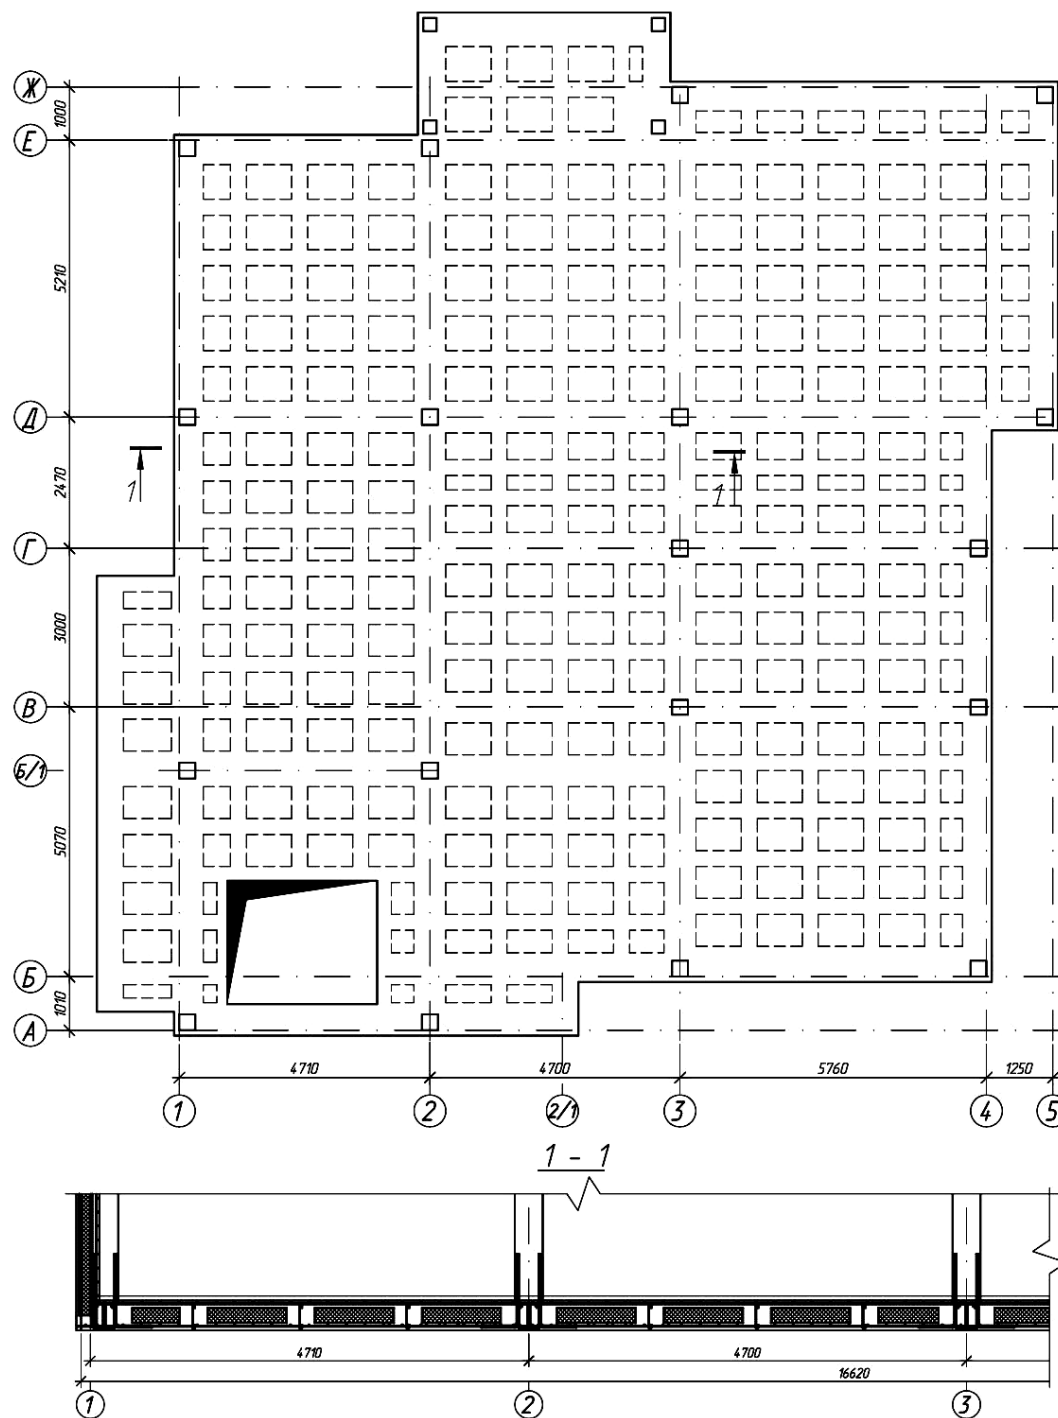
План і фрагмент перерізу фундаментної плити будівлі курортного готелю
